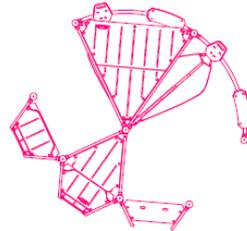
Pérgola juvenil y dibujo en planta
